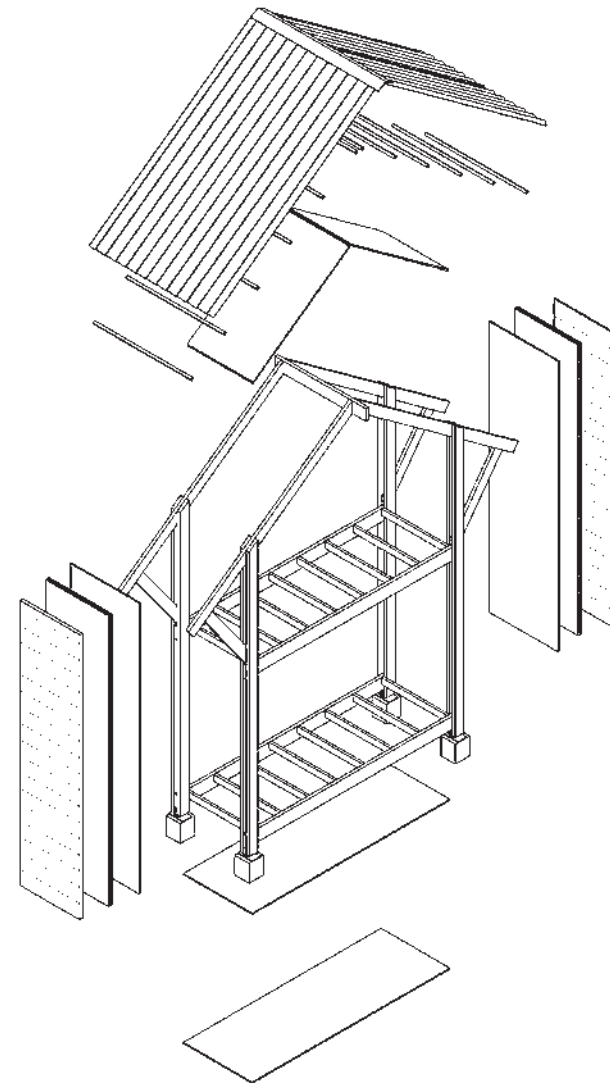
Elementos constructivos del prototipo Apan 3. Autor: Dellekamp Schleich. Fuente: Archdaily.
